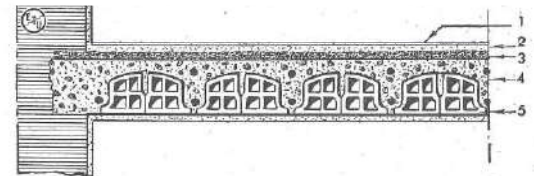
PLANCHER EN BÉTON ARMÉ ET BRIQUES CREUSES COMMUNES - 1 Sol - 2 Sous-couche - 3 Coulage du béton - 4 Briques creuses.
